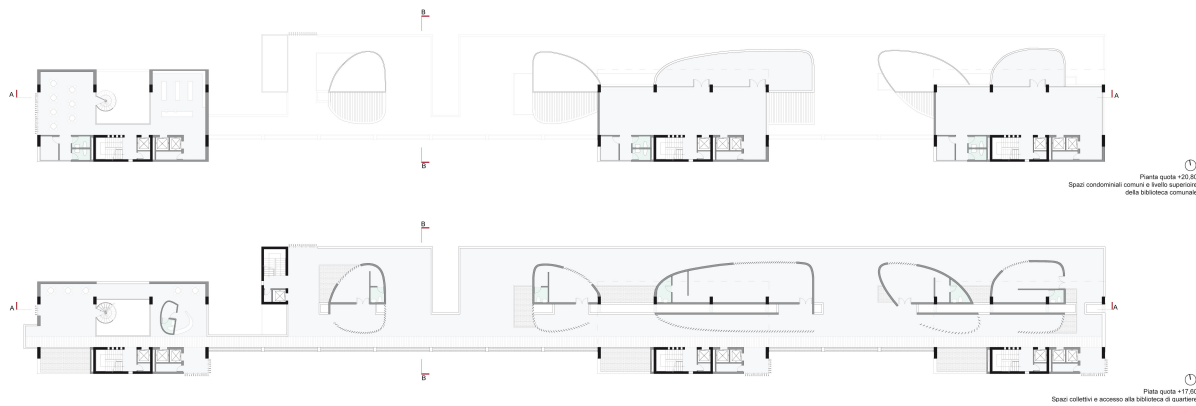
Pianta piazza sopraelevata, pianta spazi condominiali e biblioteca.
